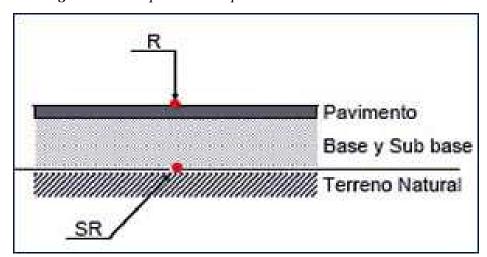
Esquema de un pavimento de concreto hidráulico
